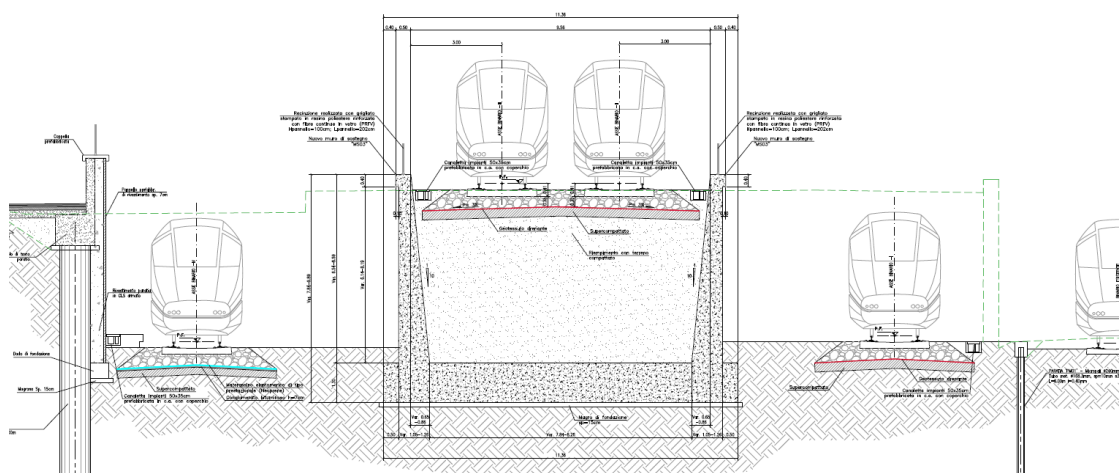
Sezione a nord del nuovo sottopasso del binario dispari del “passantino” (sezione muro MS03)
